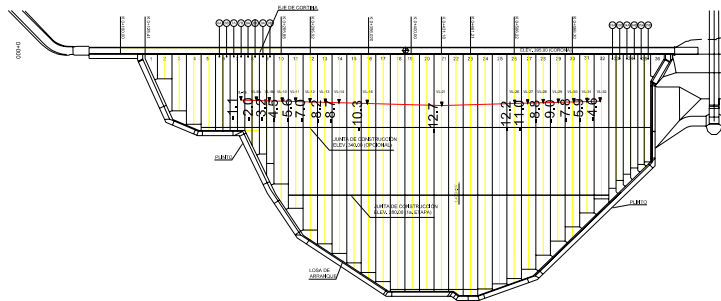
Asentamientos en losas concreto. Elev. 361. Fecha base del primer llenado.
